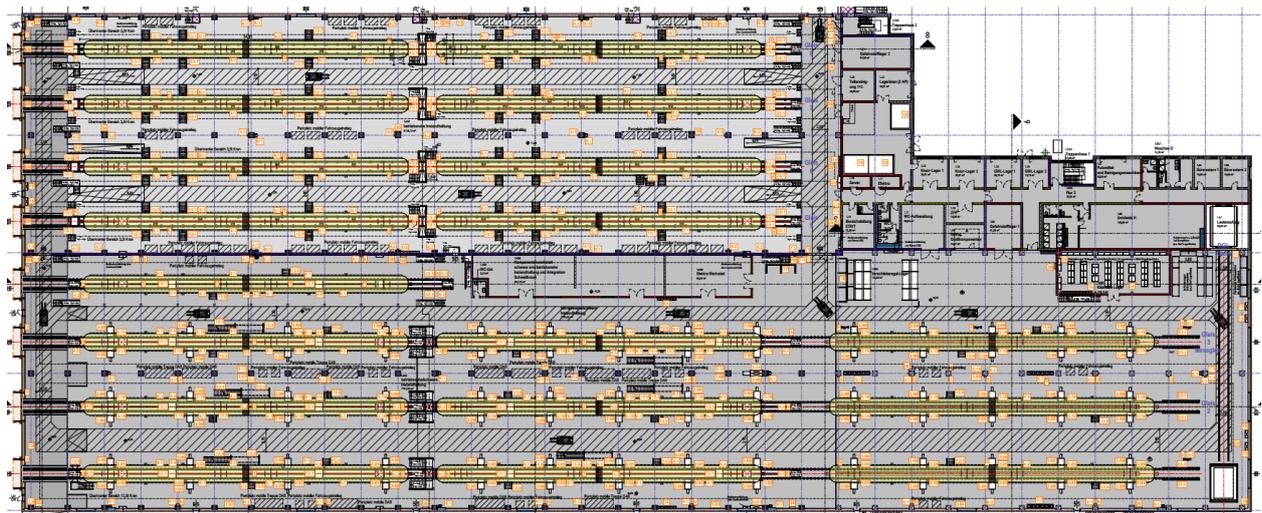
Hallengrundriss mit Betriebsgebäude
